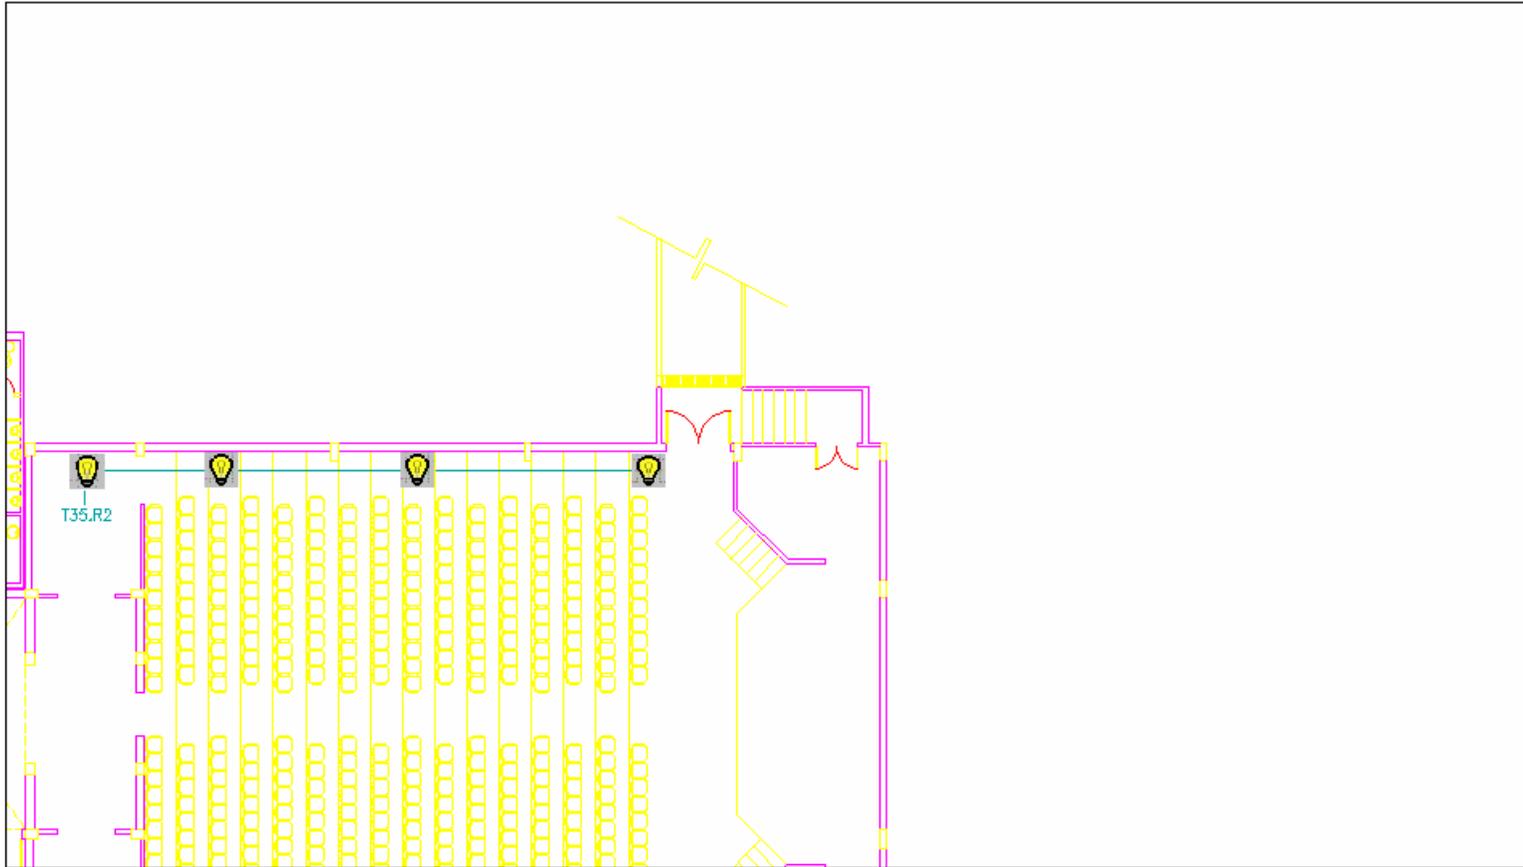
PLANO ILUMINACION PLANTA BAJA SECCION 6
